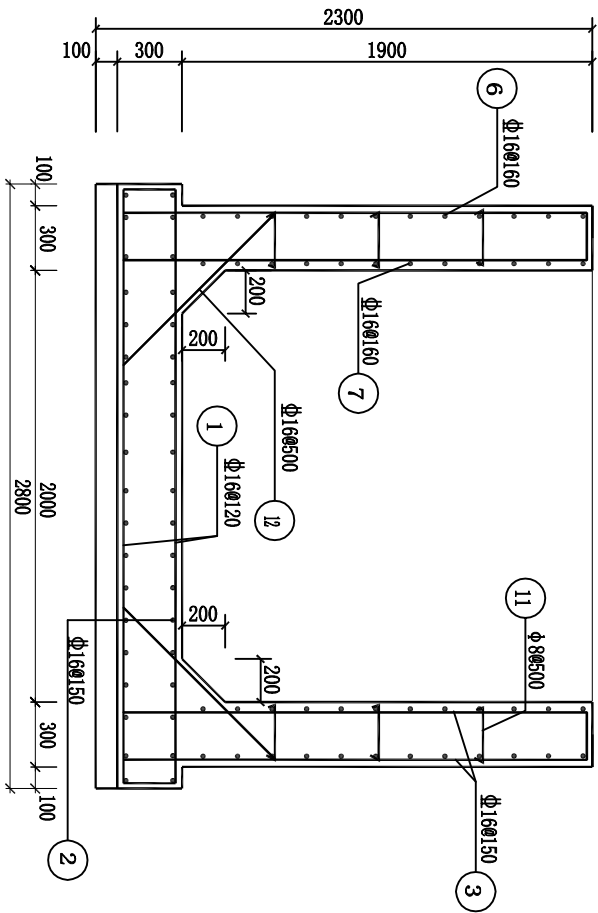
[(6.0~10.0)×2.0×1.9钢筋混凝土转弯电缆井 (E-2-5) (二)]
